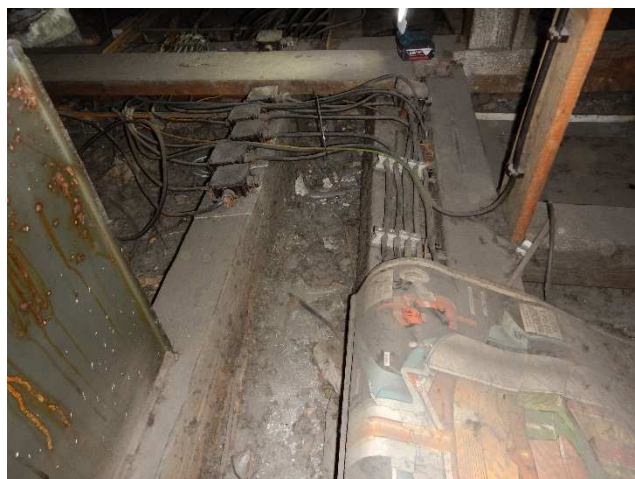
NV3– mezera mezi trámem a stěnou;
